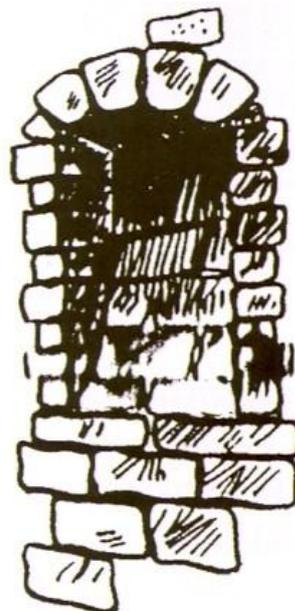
Сбросной проем от клозета в стене здания XII в.
